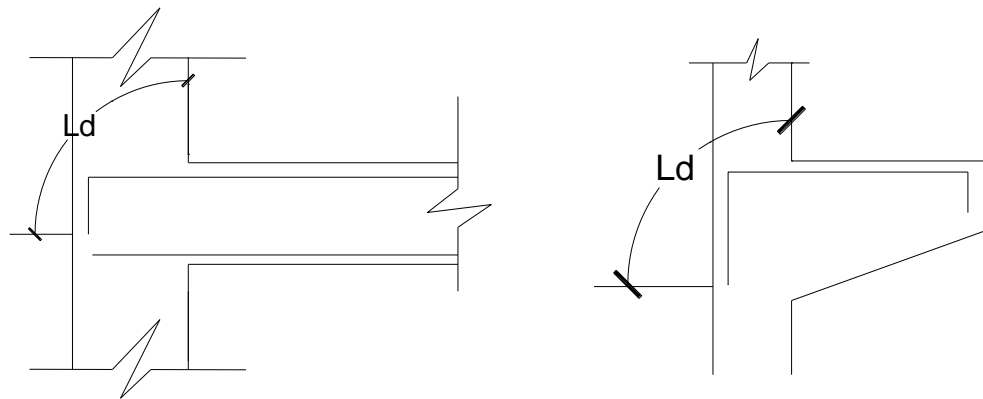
Vista del anclaje de las varillas de acero en una estructura de concreto
